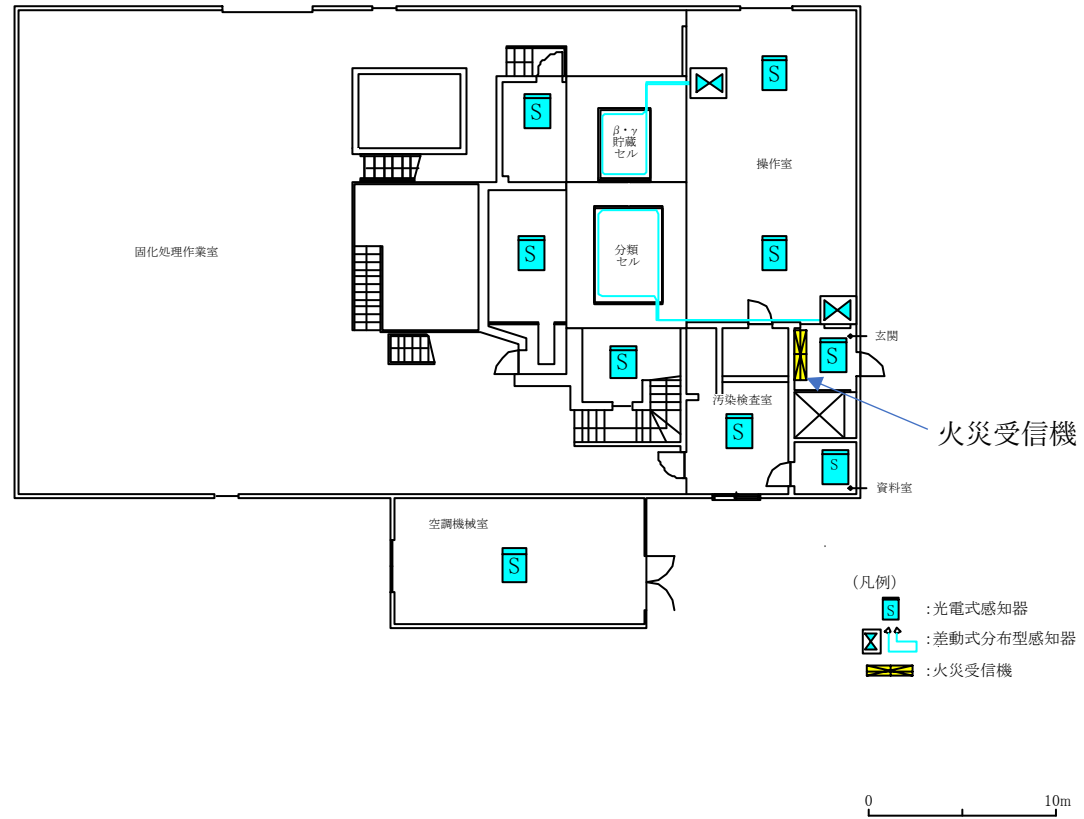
1 0 β・γ 固体処理棟Ⅳ 1 階平面図
